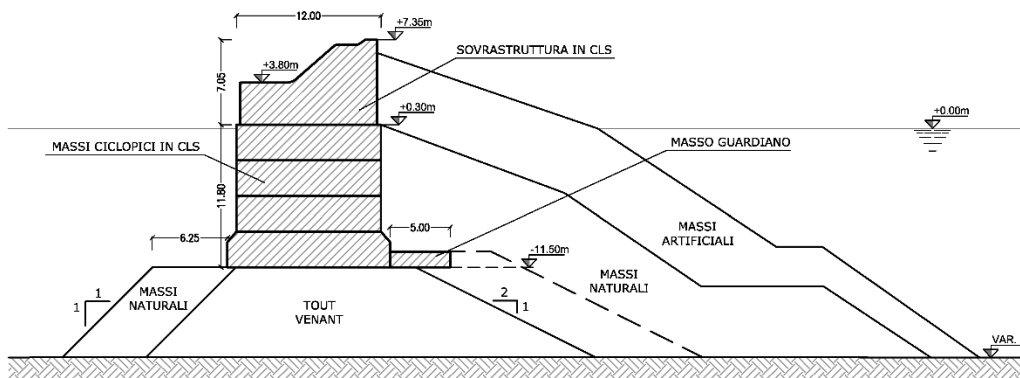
SEZIONE TIPO DEL TRATTO A PONENTE DELLA DIGA ESISTENTE – TRATTI C’-D’, D’-D
